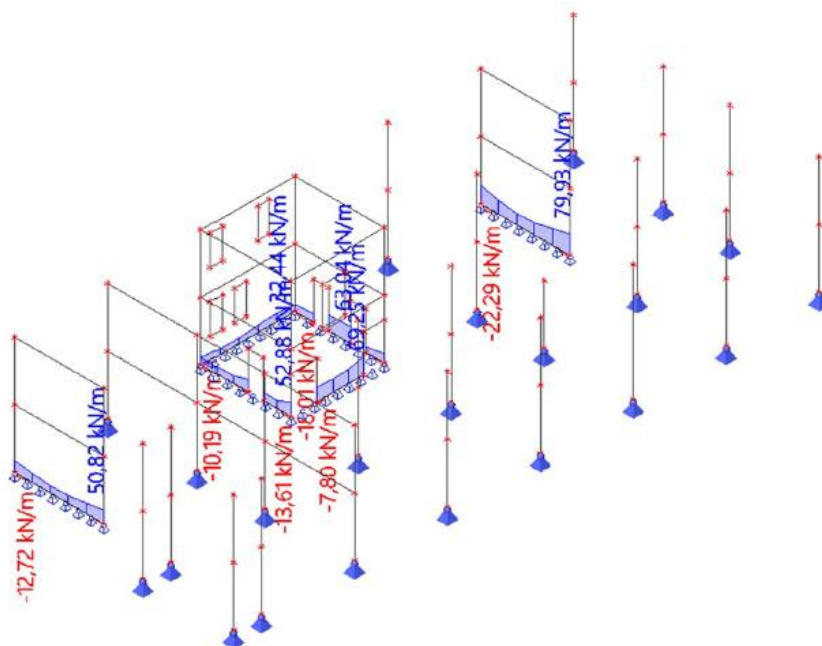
půdorys 1.NP konstrukčního systému – model E
